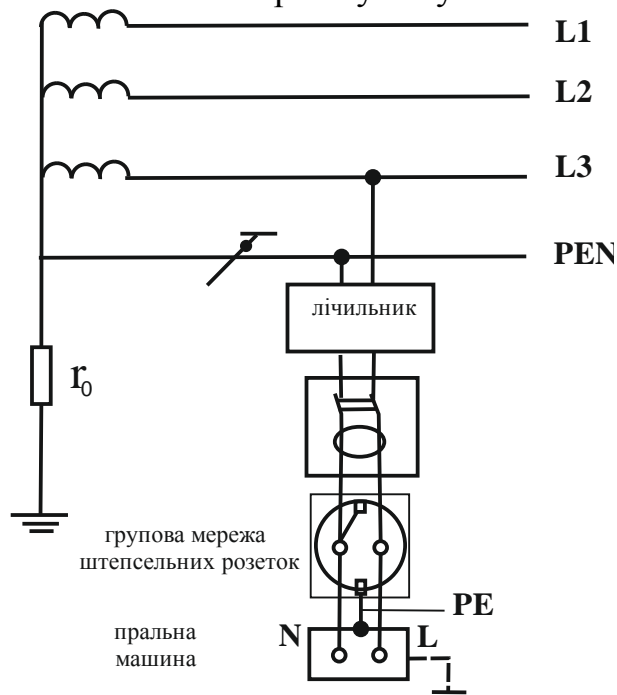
Система TN- С з приєднанням корпусу електроустановки до нейтралі джерела живлення через вивід в розетки
